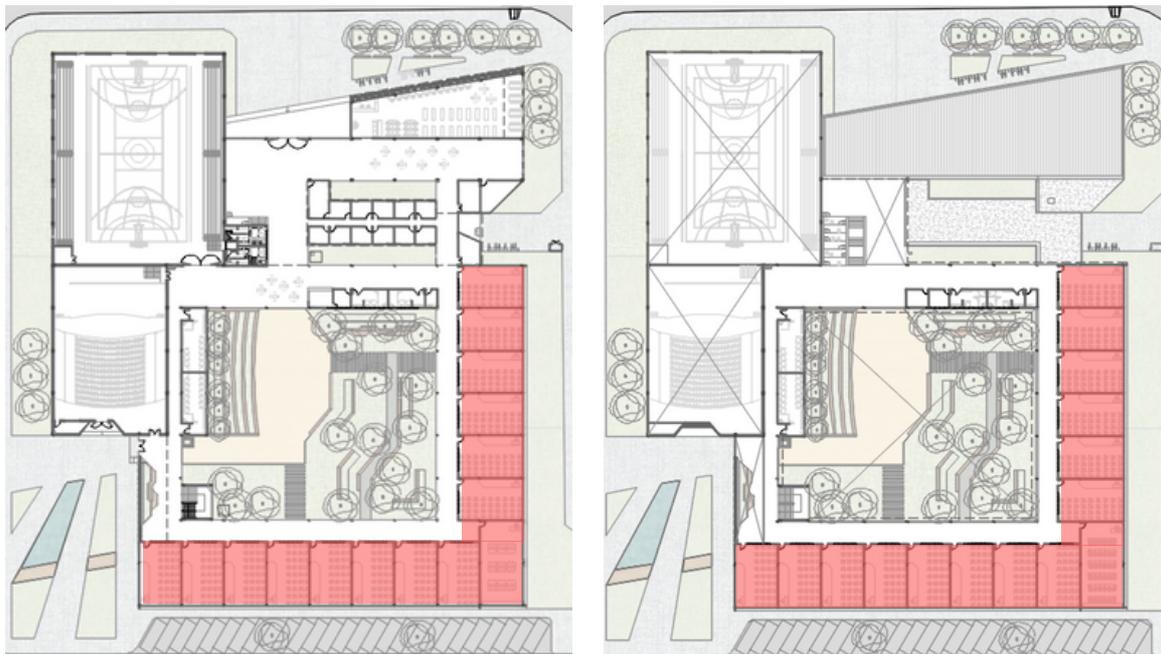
e 59: Plantas baixas do térreo (esquerda) e pavimento superior (direita) com localização das salas de aula, destacadas em vermelho. Fonte: Autoria própria.
